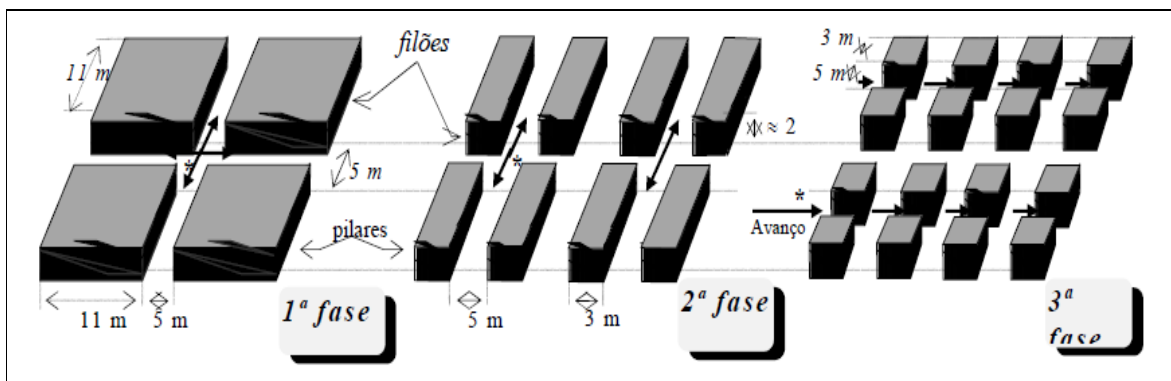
Exploração sub-horizontal por câmaras e pilares (Adaptado de C. D. GAMA, 2002)
